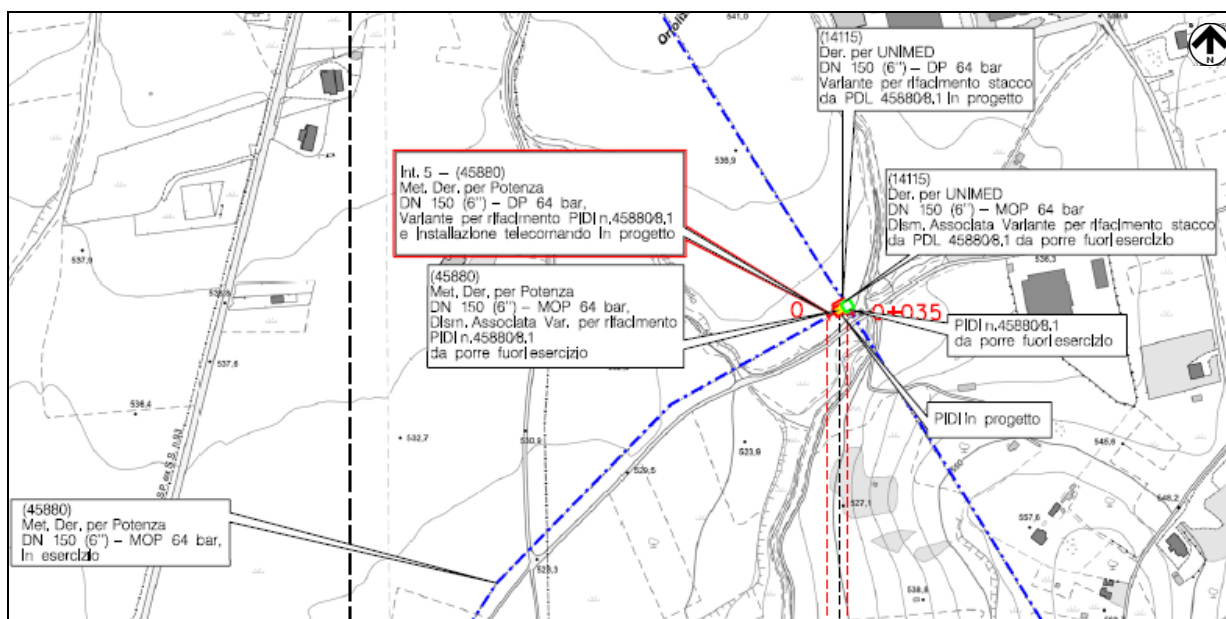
/D.b – Planimetria 1:5.000 con localizzazione dell'area dell'Intervento n.5 (progetto in rosso, dismissione in verde, esistente in blu)
